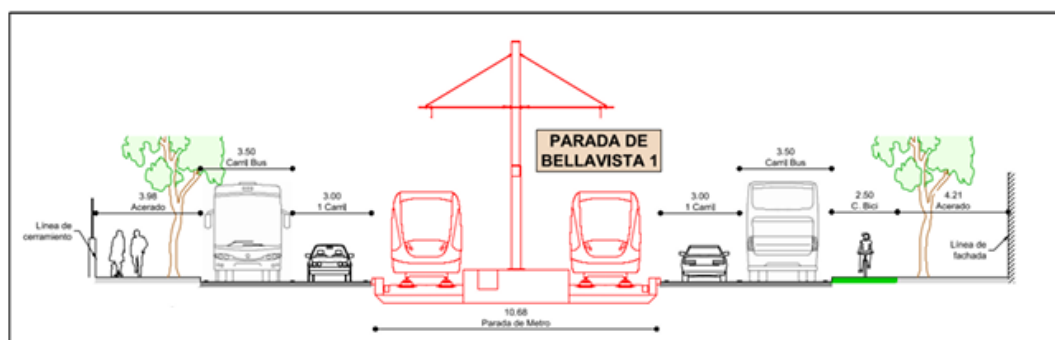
Avda. de Bellavista. Sección viaria futura propuesta
